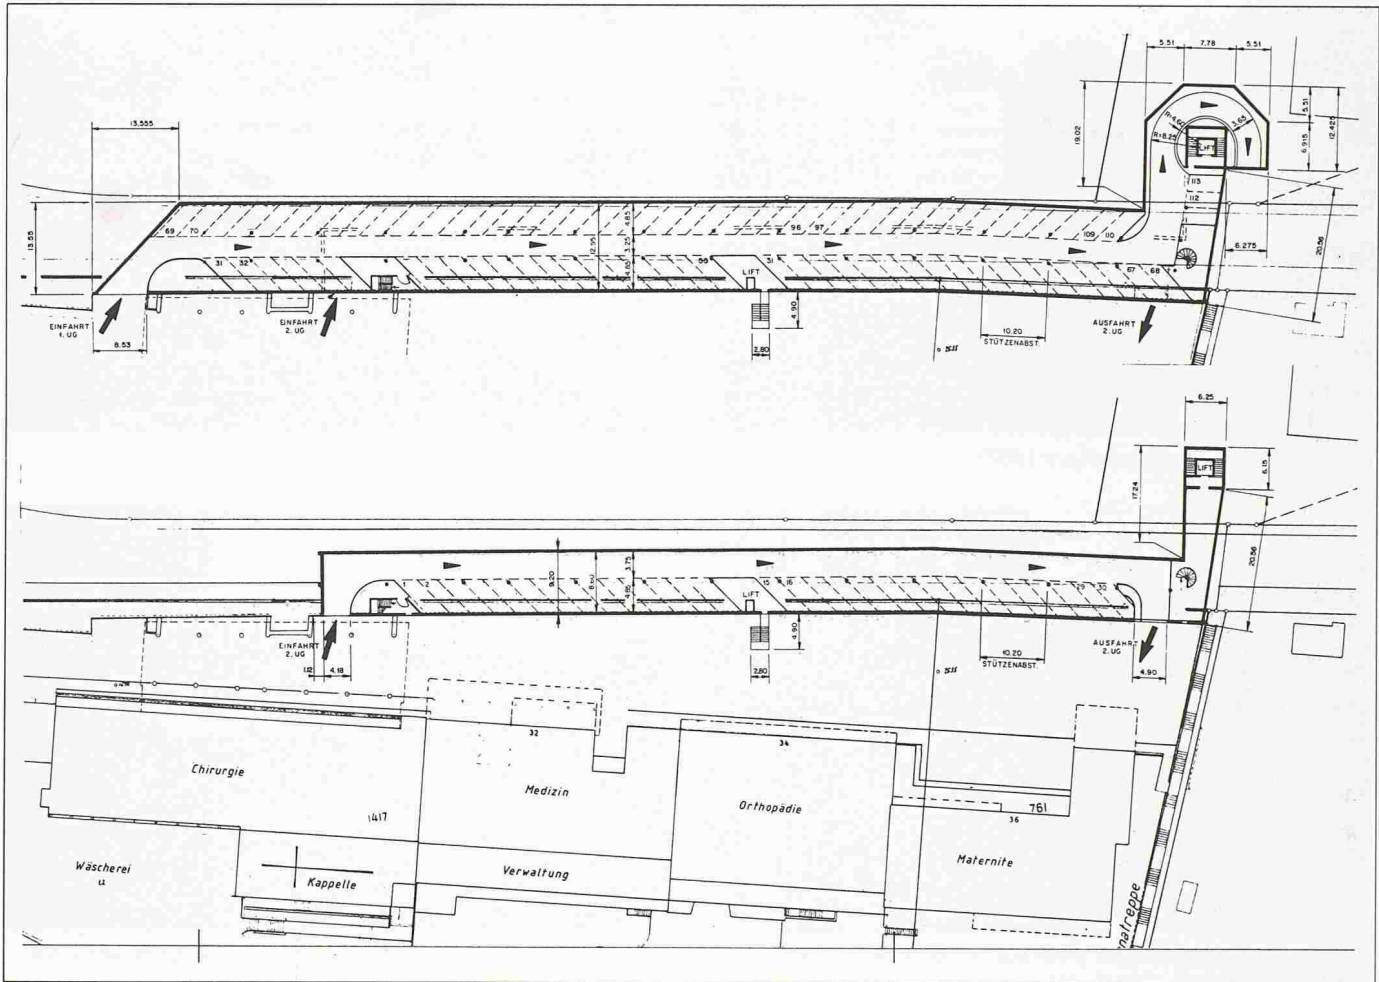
Situationsplan 1:500 des 1. Untergeschosses (oben) und 2. Untergeschosses (unten)
